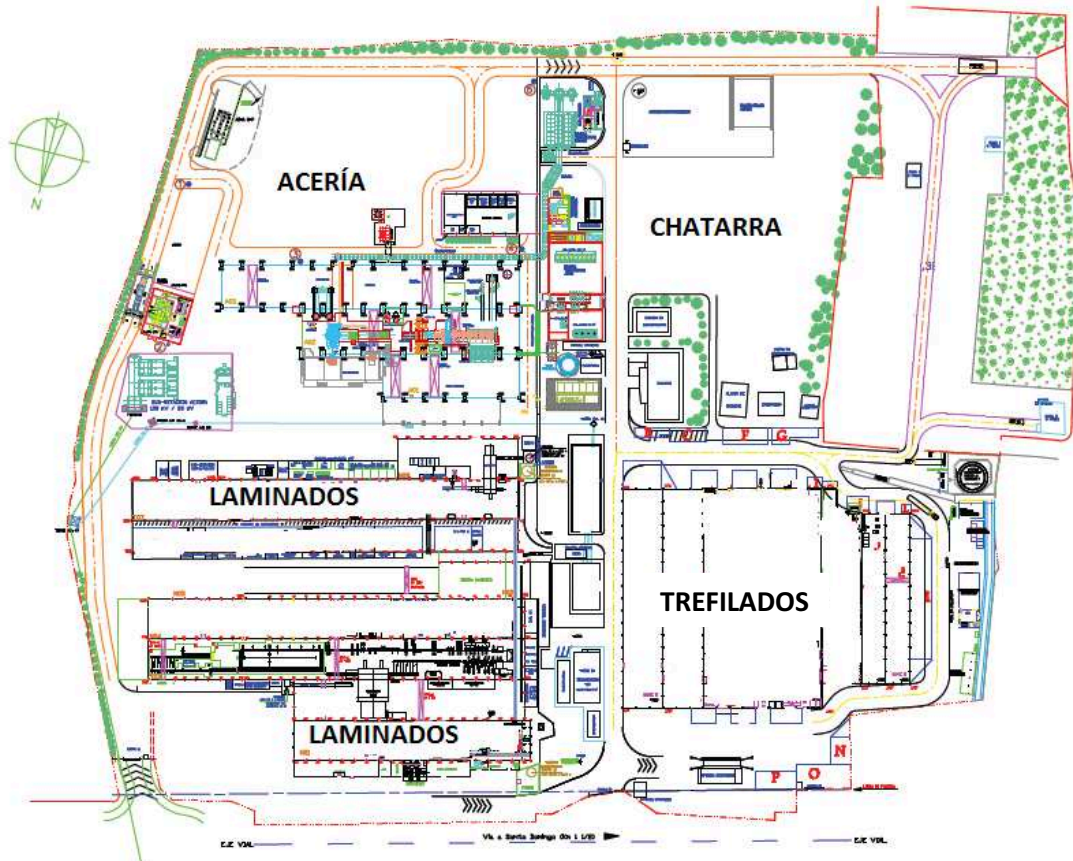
Esquema de ubicación de áreas en la planta de ADELCA
